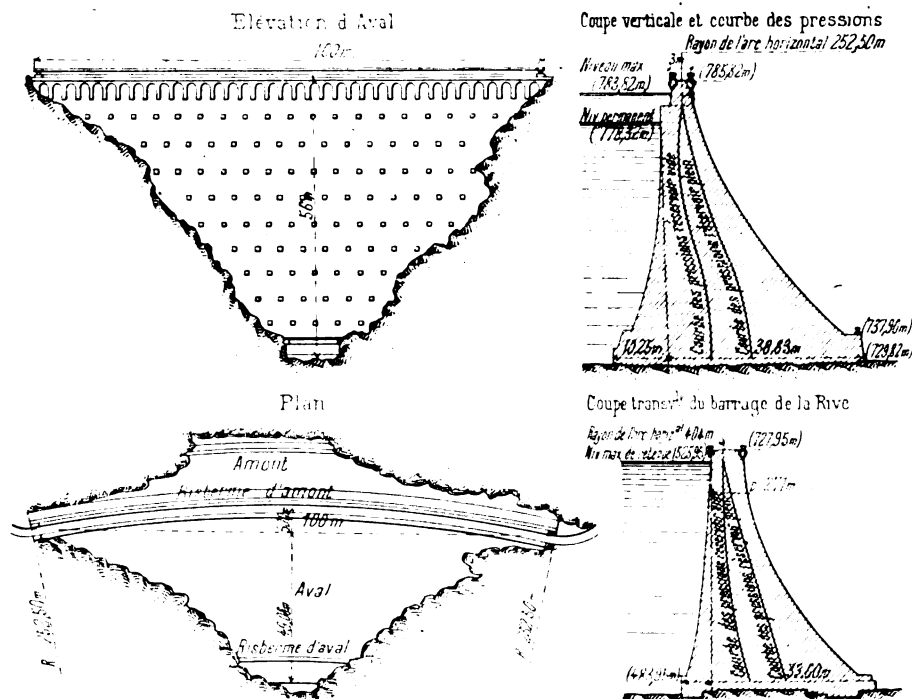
Plan, coupe et élévation du barrage du Gouffre d'Enfer.
